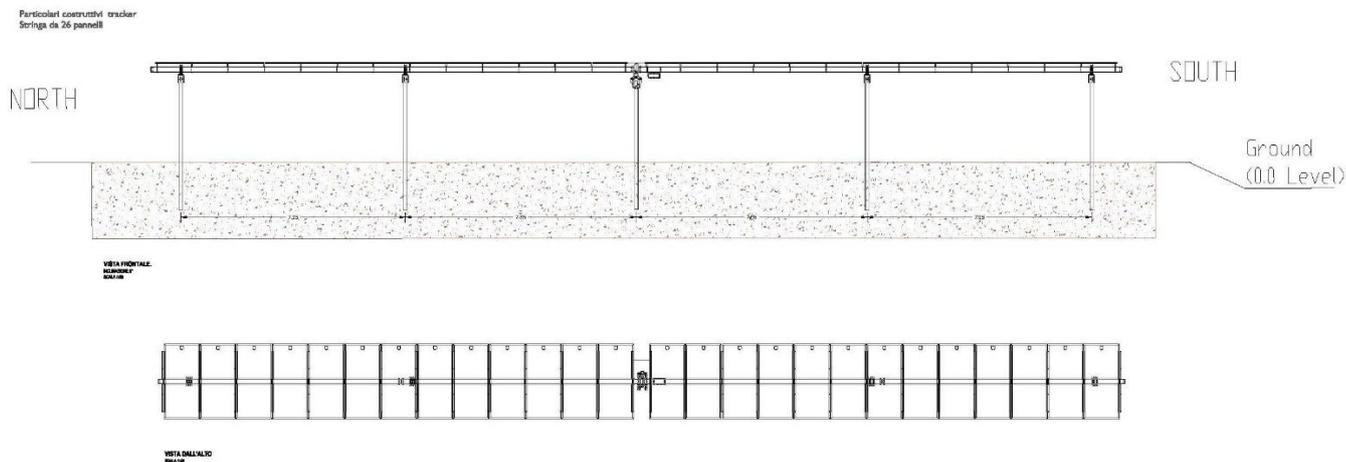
Vista laterale e vista dall'alto della singola stringa da 26 moduli
